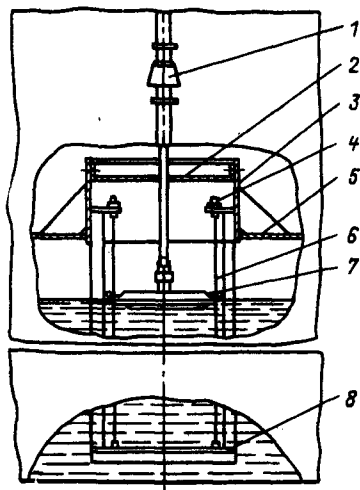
Монтаж поплавка при установке уровнемера УДУ-10 на железобетонном понтоне:
